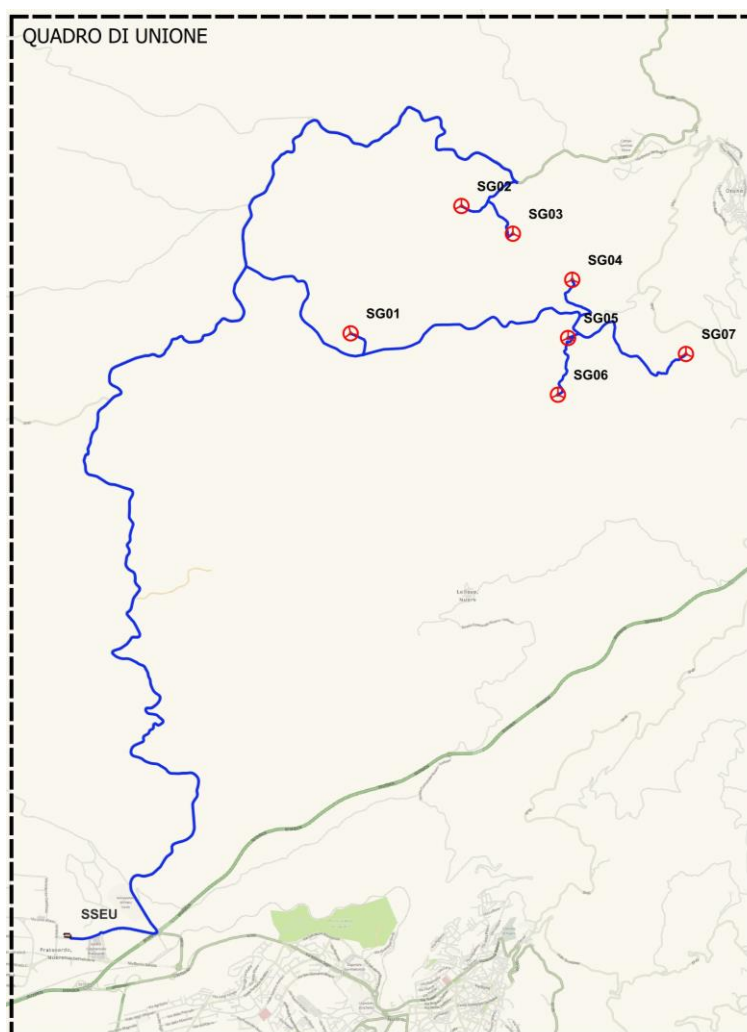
layout progettuale dell'impianto eolico CE Nuoro Nord
